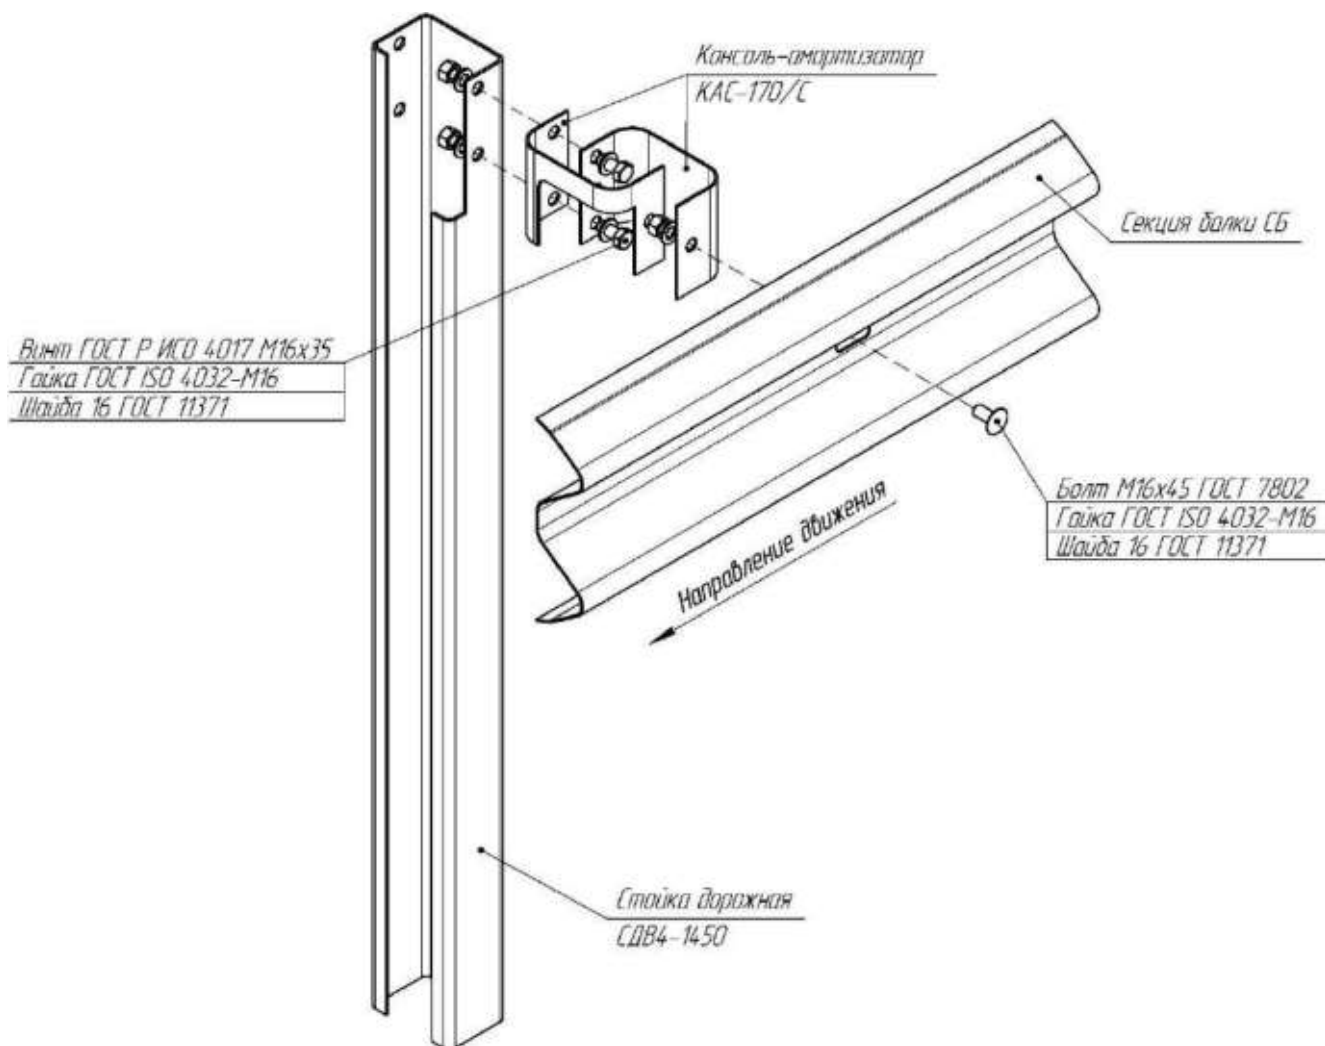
Схема сборки конструкции №15 (Изм. №1)
